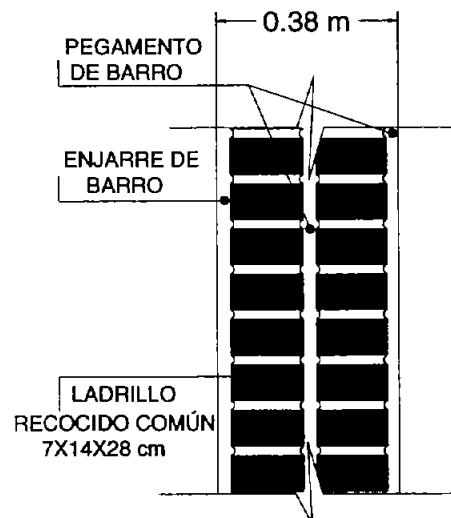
Sección de cortes en alzado y planta de sistema constructivo típico (indígena).
